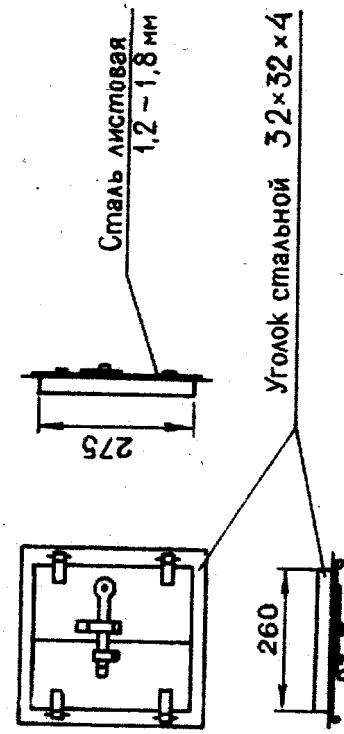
Рамка с дверкой для варочной камеры печи В. А. Потапова
